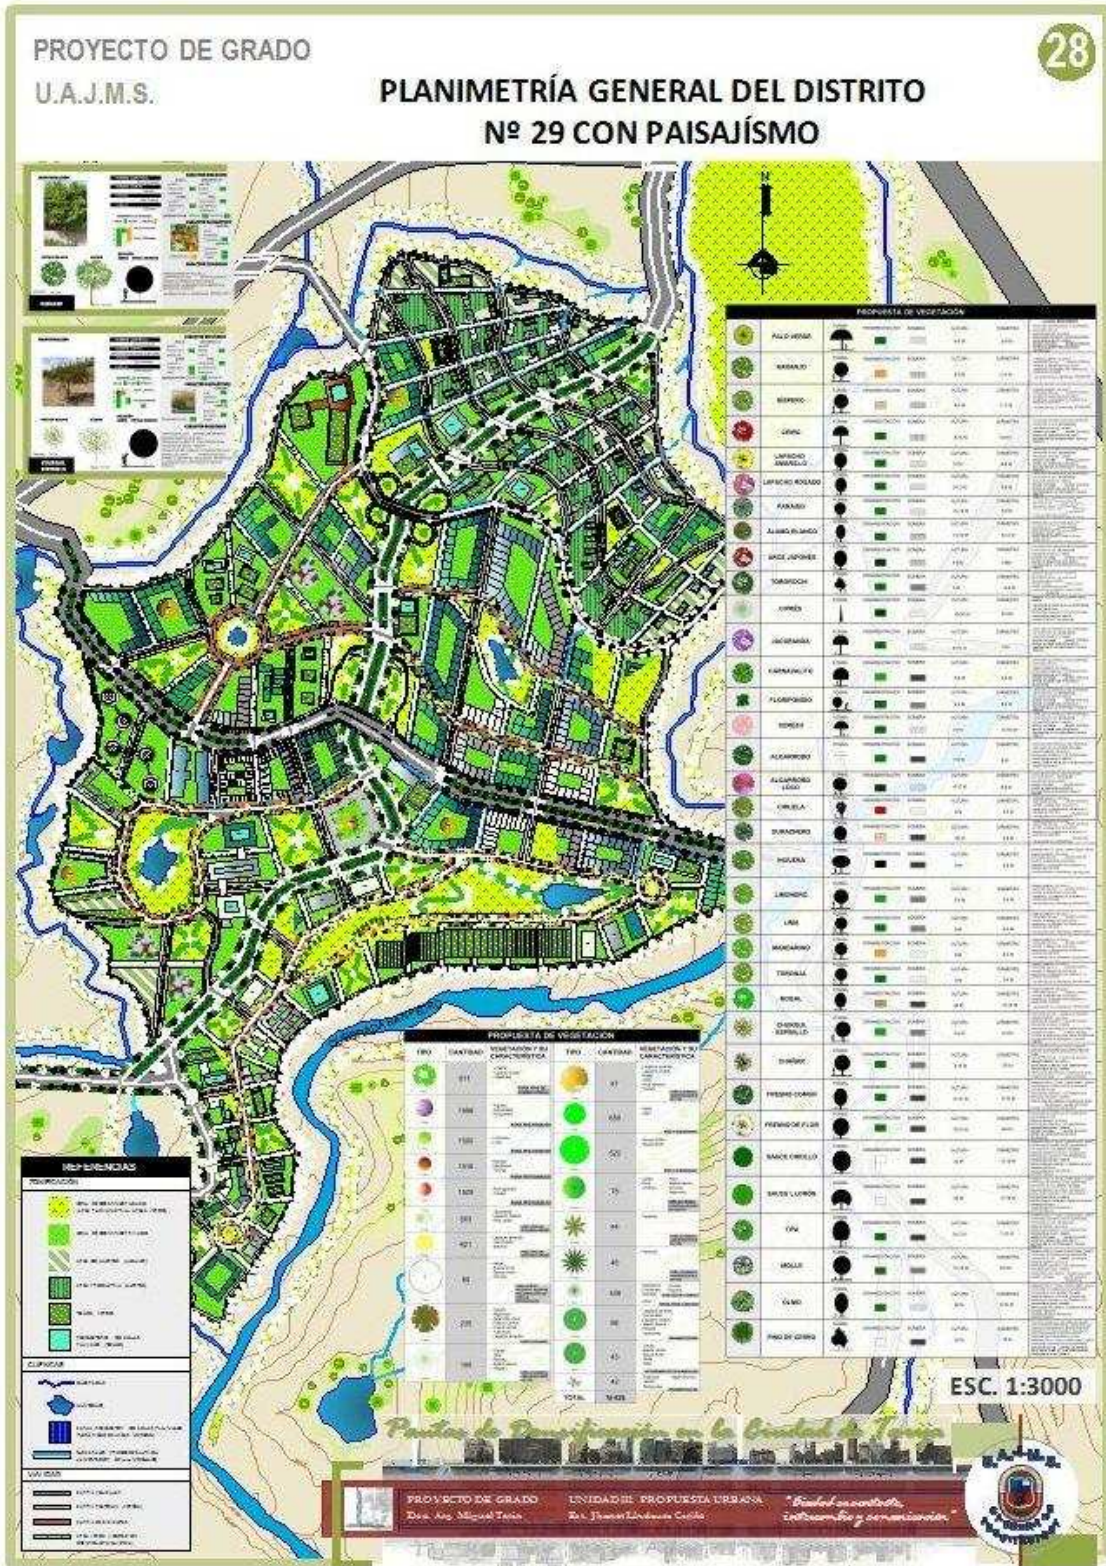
Planimetría General del distrito N° 29 con paisajismo
